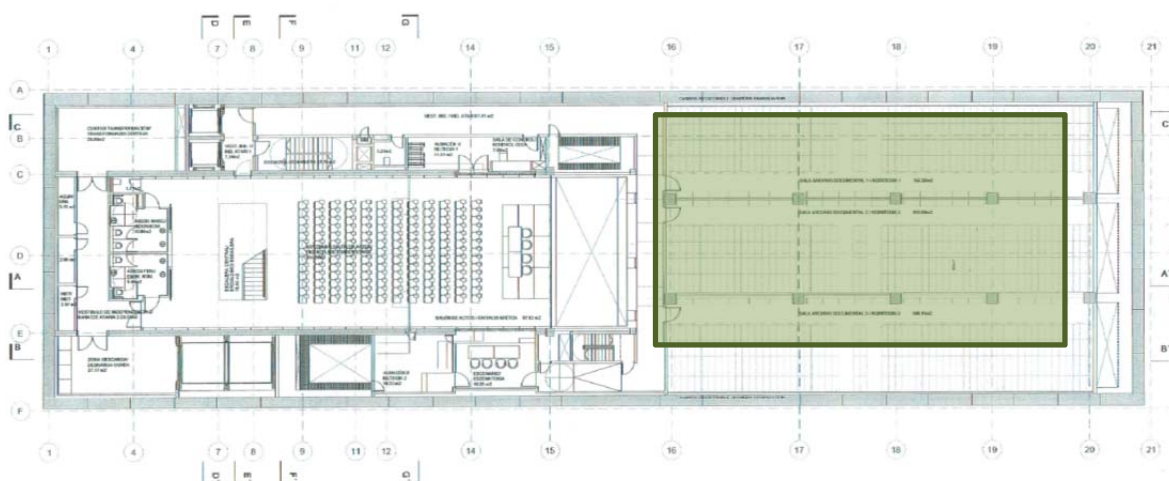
Planta sótano-1 del edificio, indicando ubicación prevista para el pabellón sobre el archivo.
